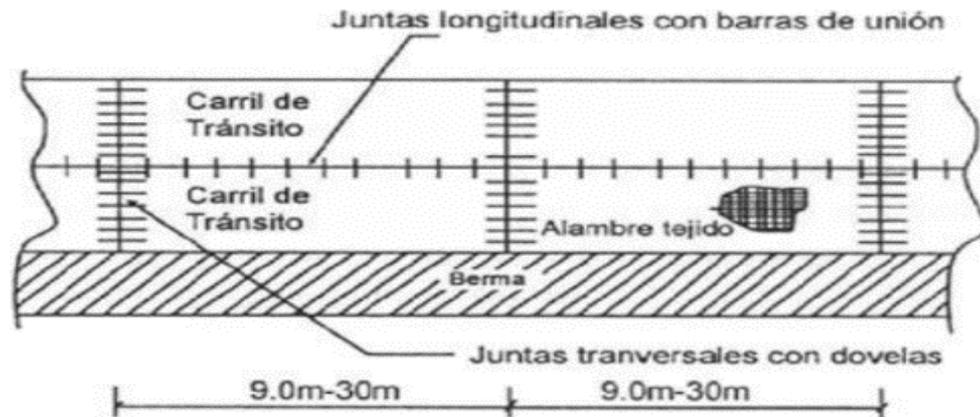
La composición del pavimento articulado de concreto reforzado. [15]
